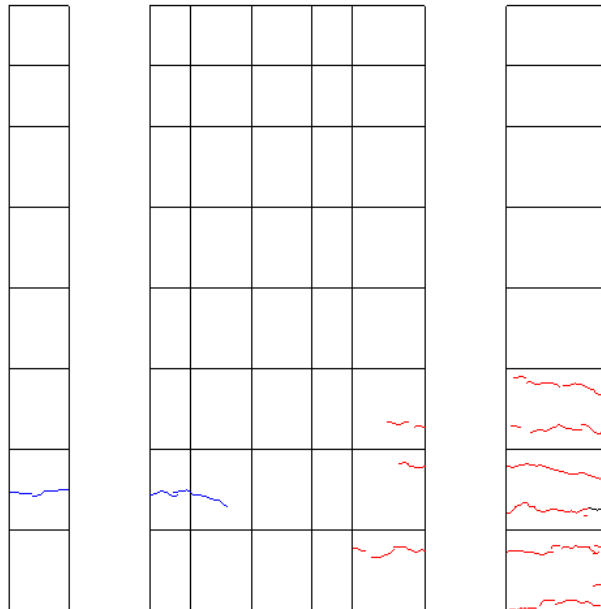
R=-1/800 ひび割れ図
